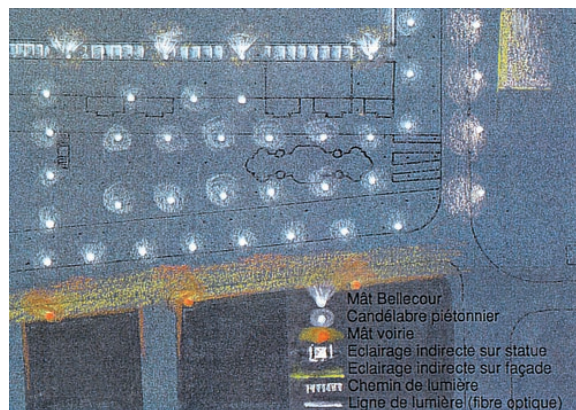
Plan d’ensemble se rapprochant du simple plan d’implantation
